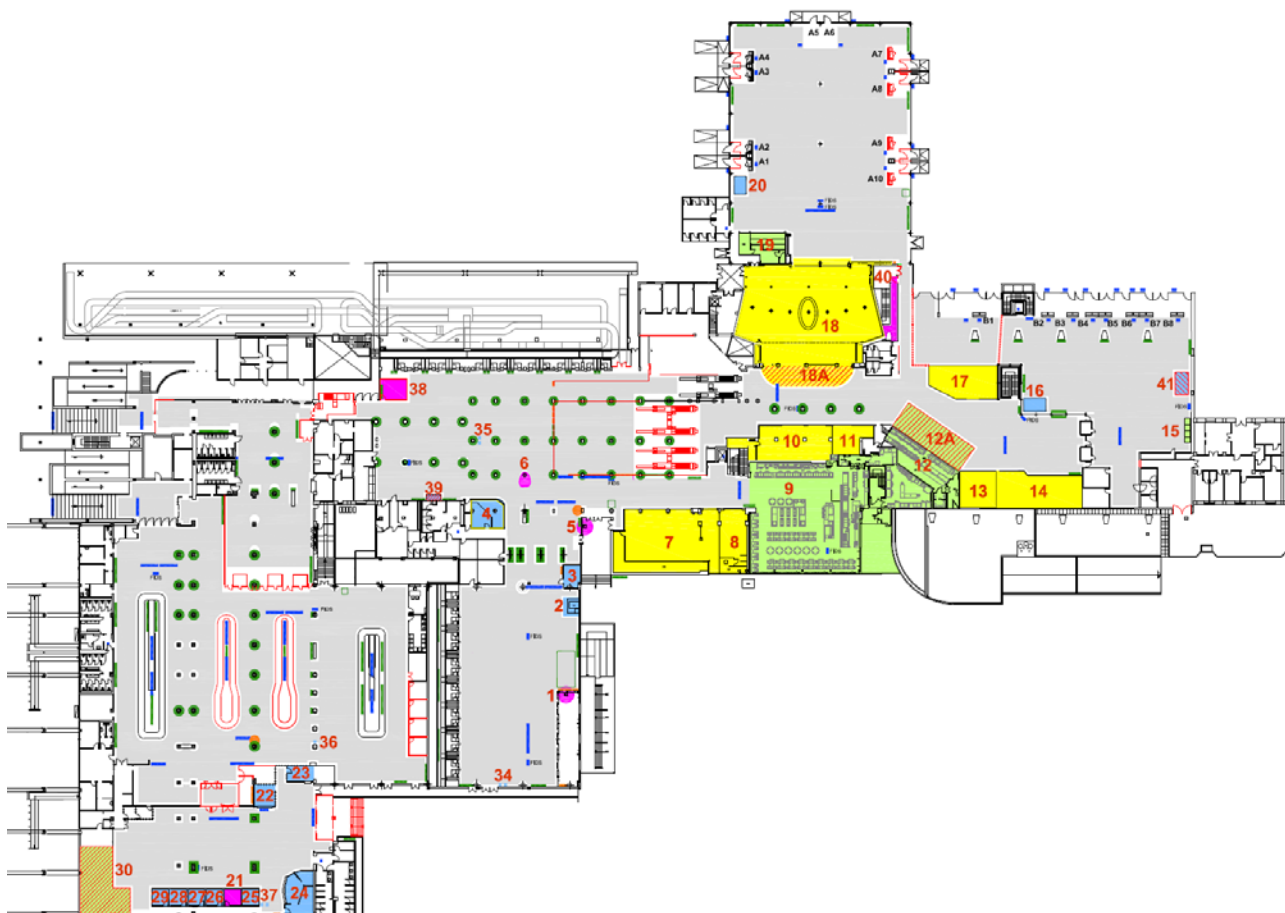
Aviazione Commerciale: Planimetria assetto futuro secondo quanto previsto nel PUA
